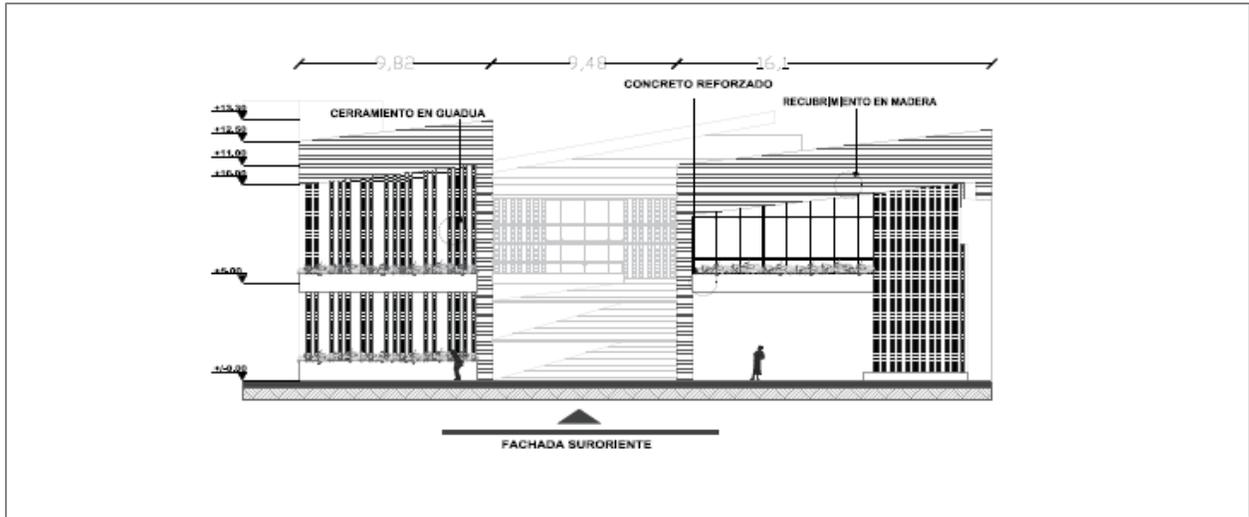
Fachada Suroriente Edificio 1 (Rubiano, 2020)
